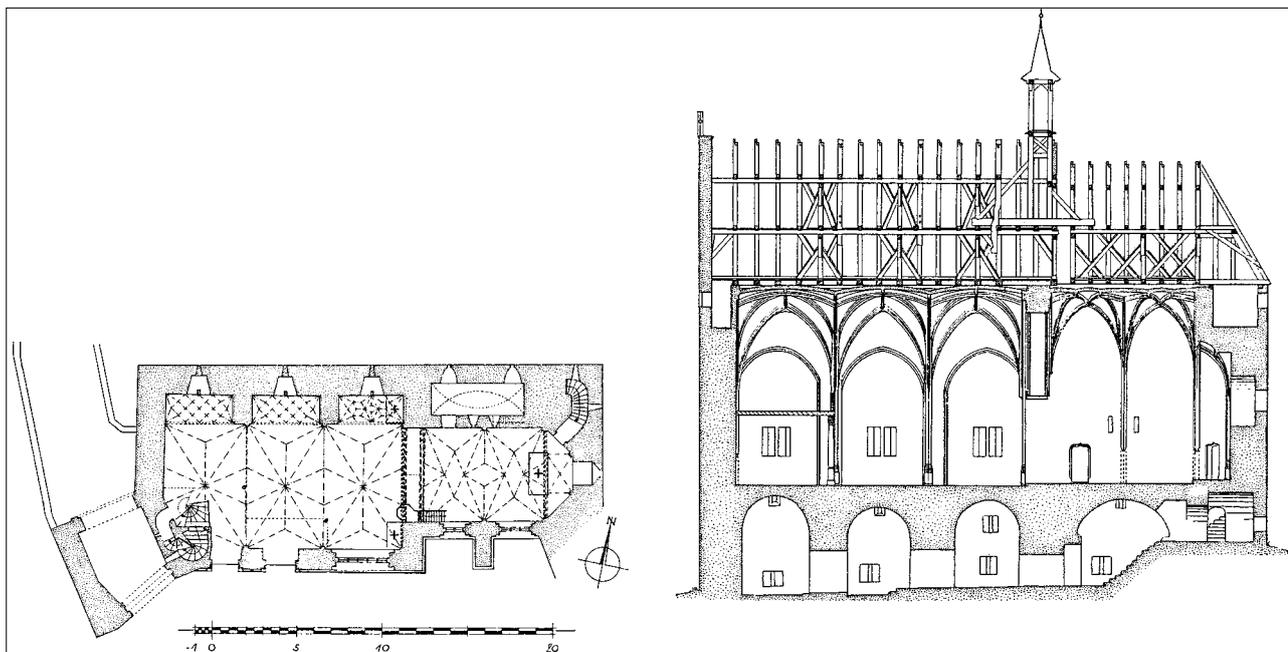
(oben): Rothenburg ob der Tauber, St. Wolfgang, Grundriss und Längsschnitt der Wehrkirche (nach Ress 1959, 423 Fig. 355).
